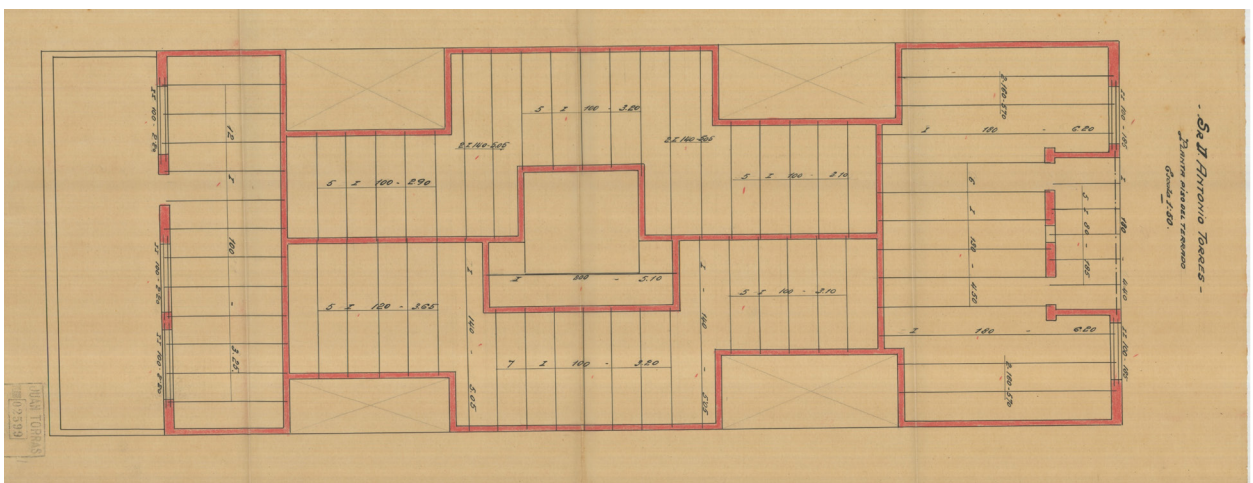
Esquema estructural planta ático de la primera versión edificio calle Roselló. Plano sin numerar. Torres, Herrería y Construcciones, S.A. FONS ANCI-631-UC 9379. Arxiu Nacional de Catalunya
